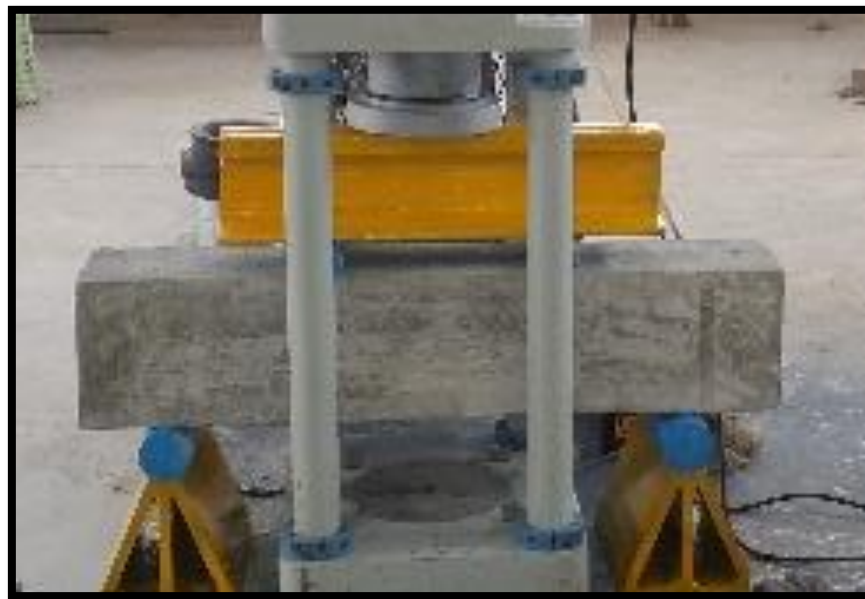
Adaptación de la máquina de ensayo a compresión.
